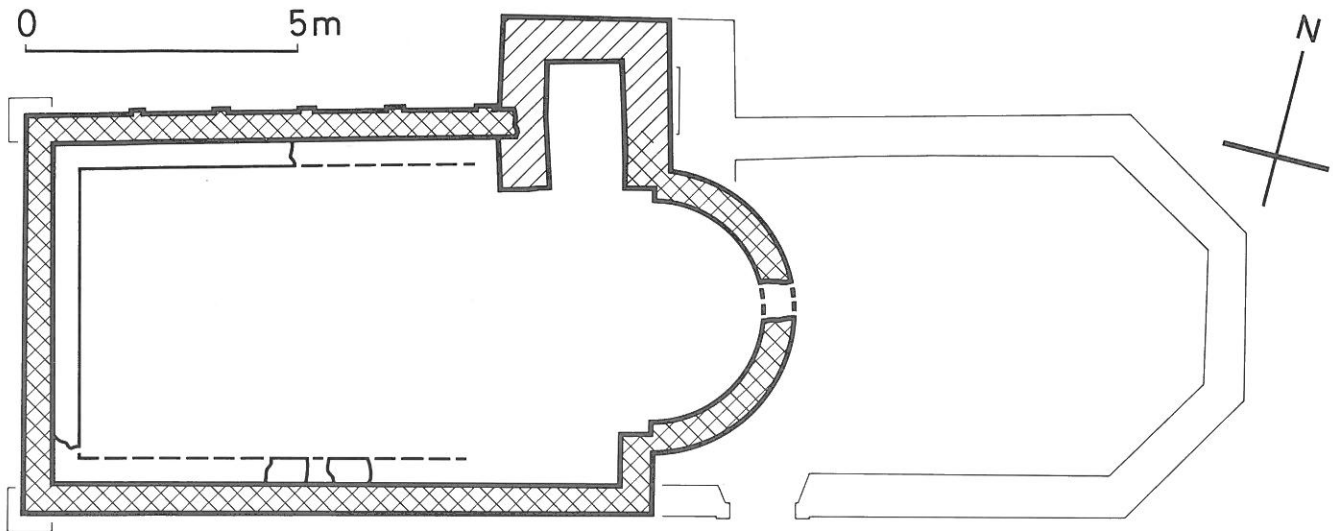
Grundriss der Anlage IV. M. 1:140
